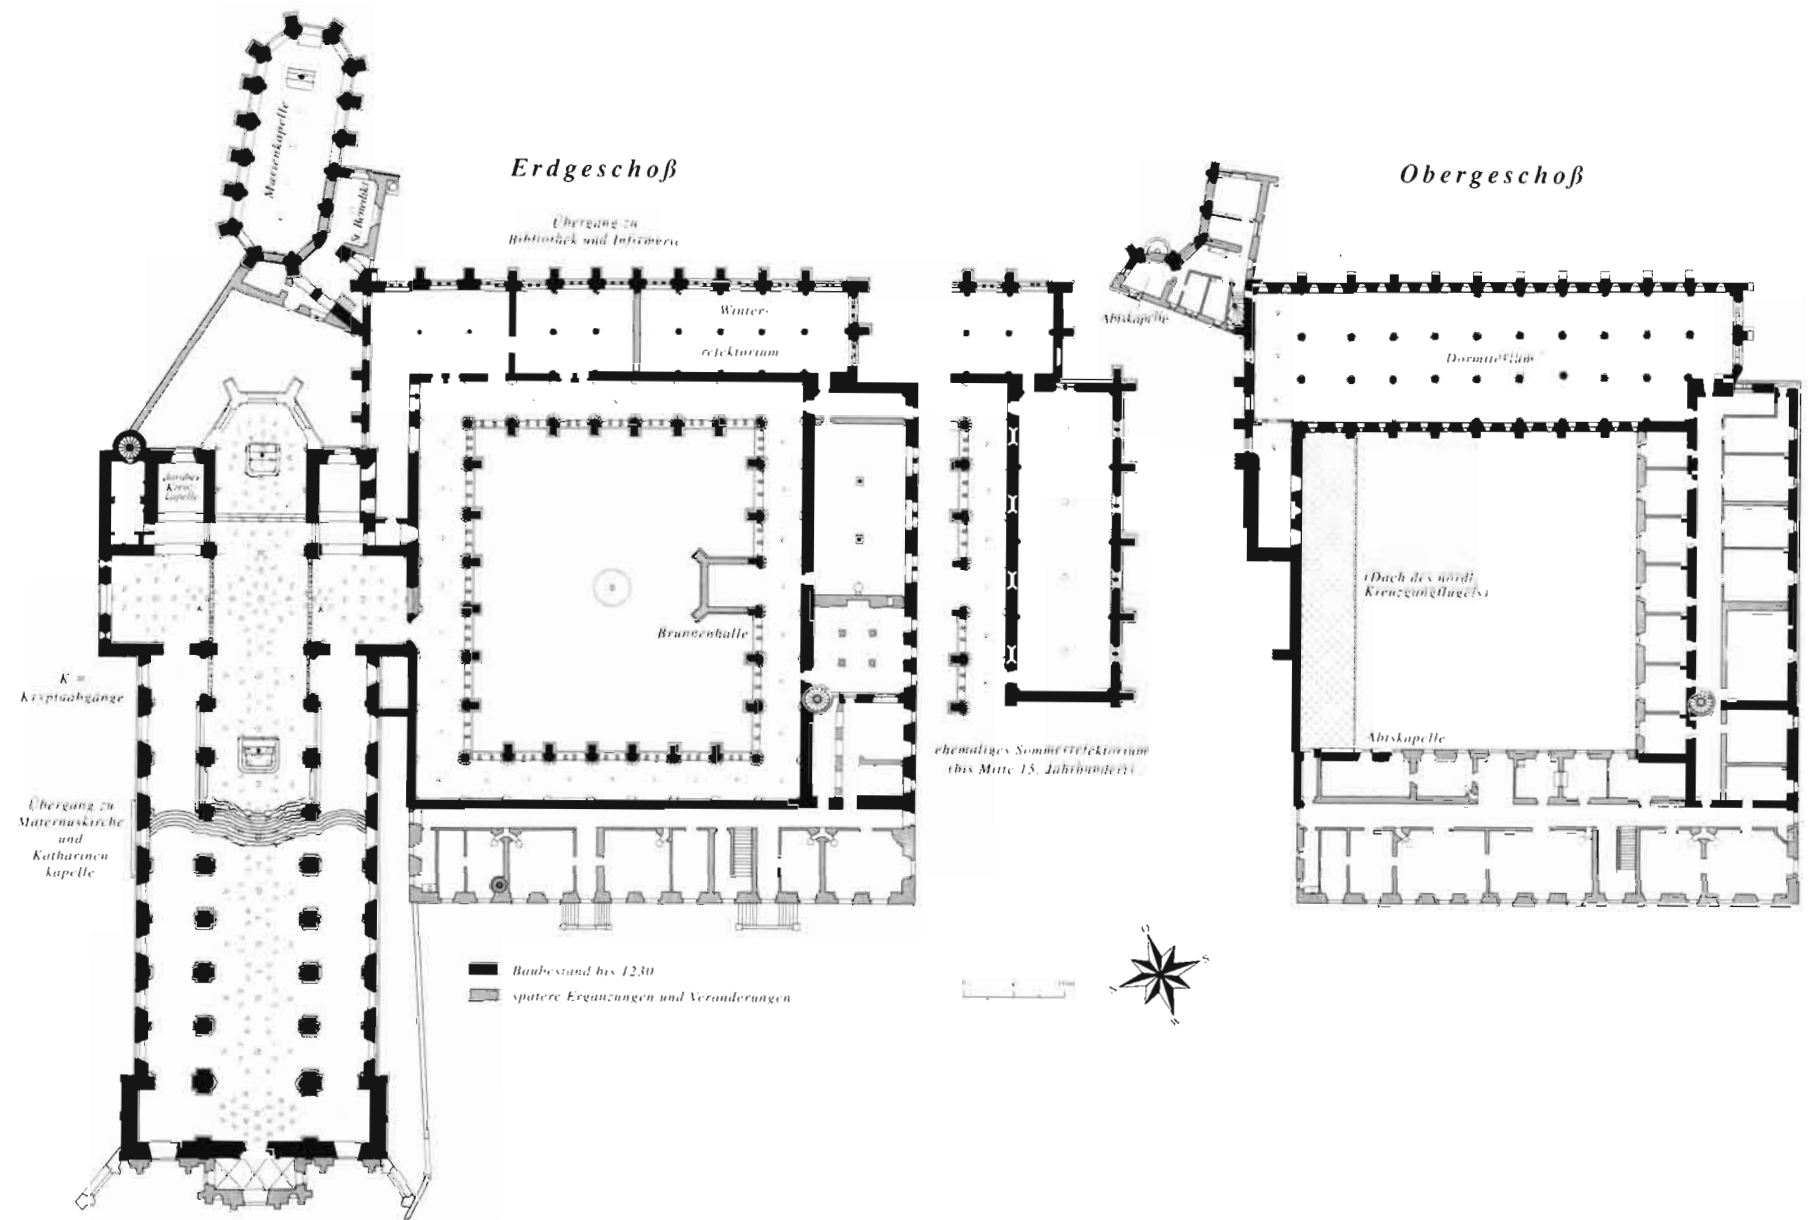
Grundriß der Klosteranlage St. Eucharius-St. Matthias. Erdgeschoß und Obergeschoß (Entwurf: P. Becker und J. Wilhelm nach älteren Plänen. Ausführung: M. Grün und T. Jarmer)
